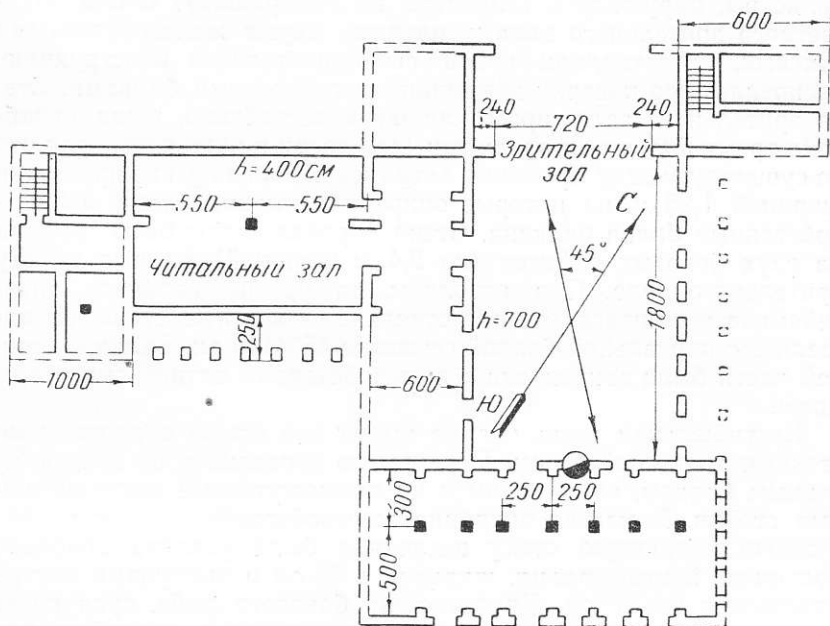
Схема плана здания клуба механического стекольного завода (пунктиром показаны разрушенные участки стен)
